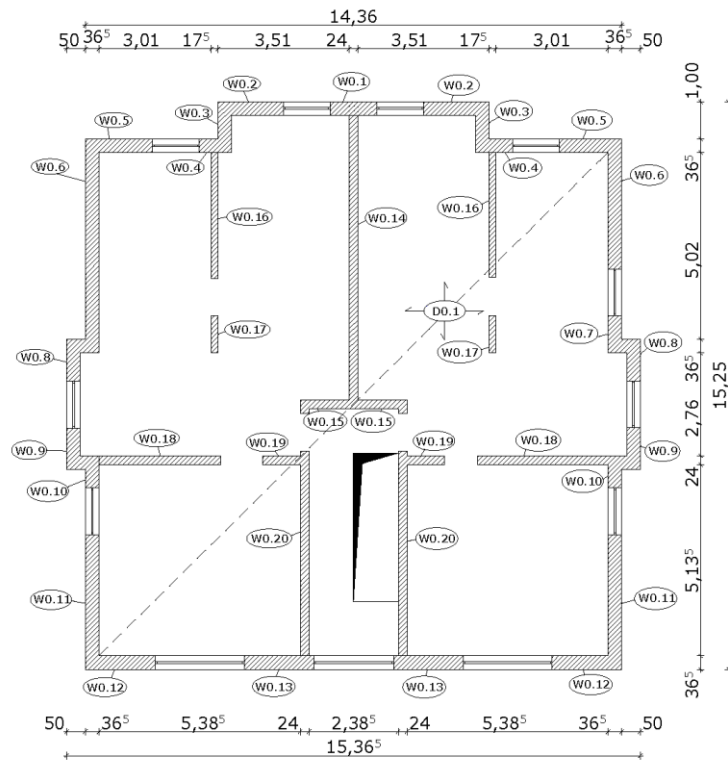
Grundriss des Erdgeschosses nach [2]
